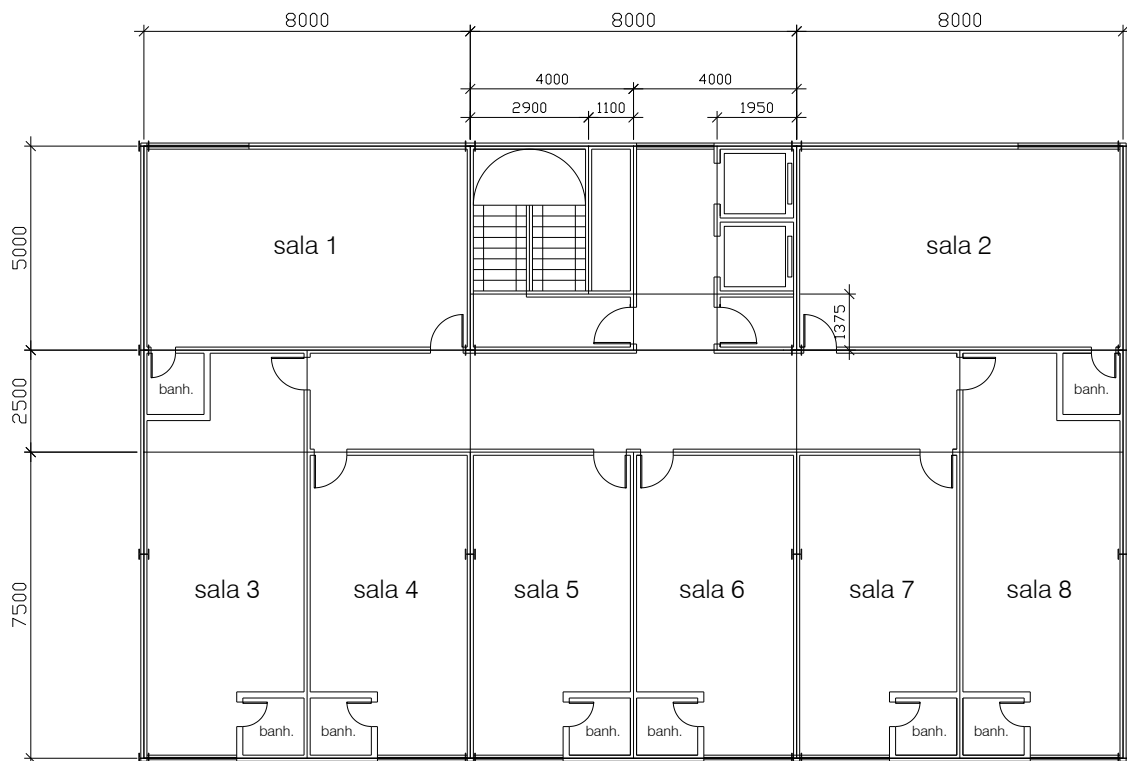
Planta Baixa do pavimento tipo – cotas em mm (Pfeil, 2022)
